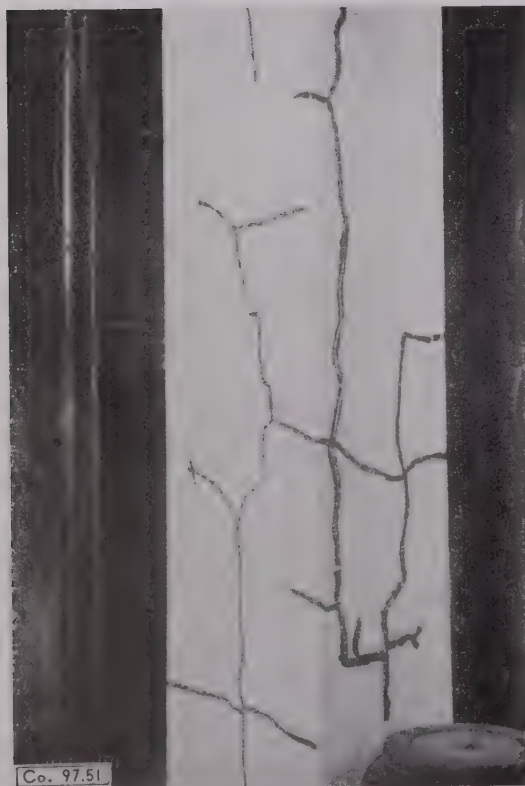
Conduit revêtu d'un enduit plâtre [6].
